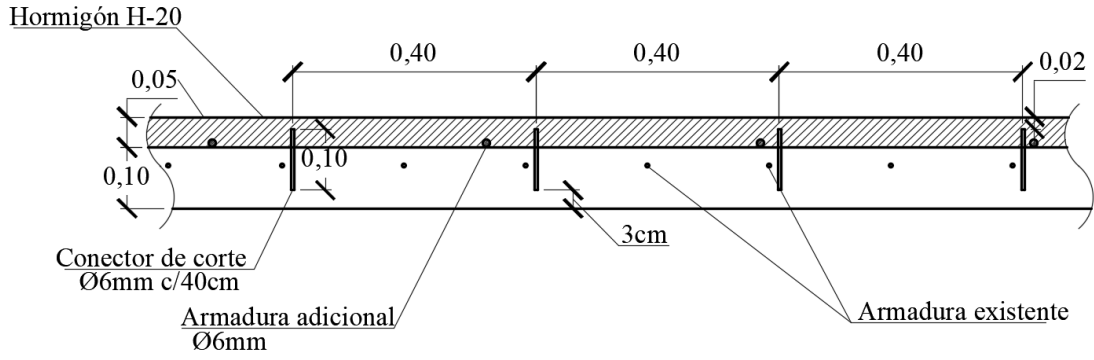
Corto genérico armadura adicional en recrecido de hormigón con conectores.
